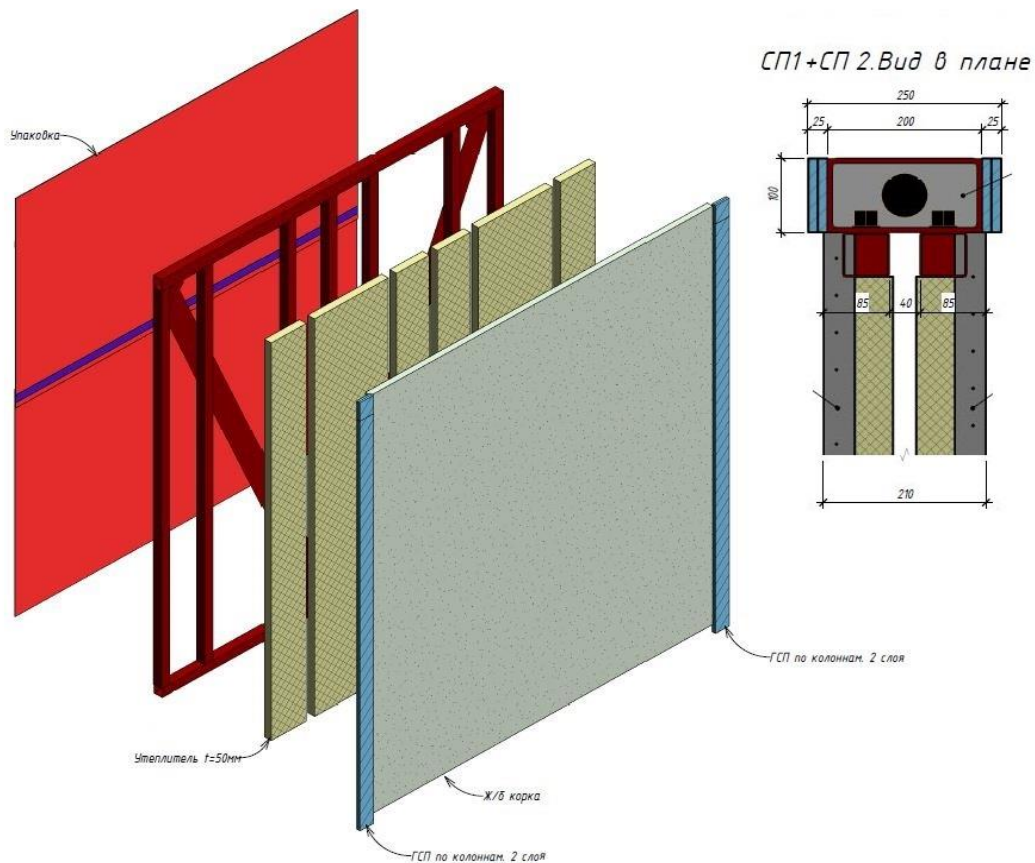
Схема конструктивного исполнения образца внутренней несущей стены
